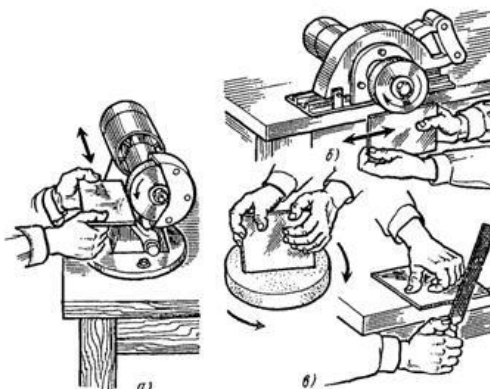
Выравнивание (подтачивание) кромок плиток: а - на стационарном точиле, б - на переносном инструменте с шлифовальным кругом, в - вручную шлифовальным кругом или рашпилем
